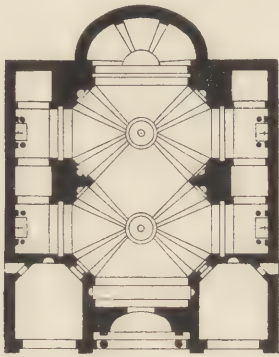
S. Antonio Abate zu Parma. Grundriss.
